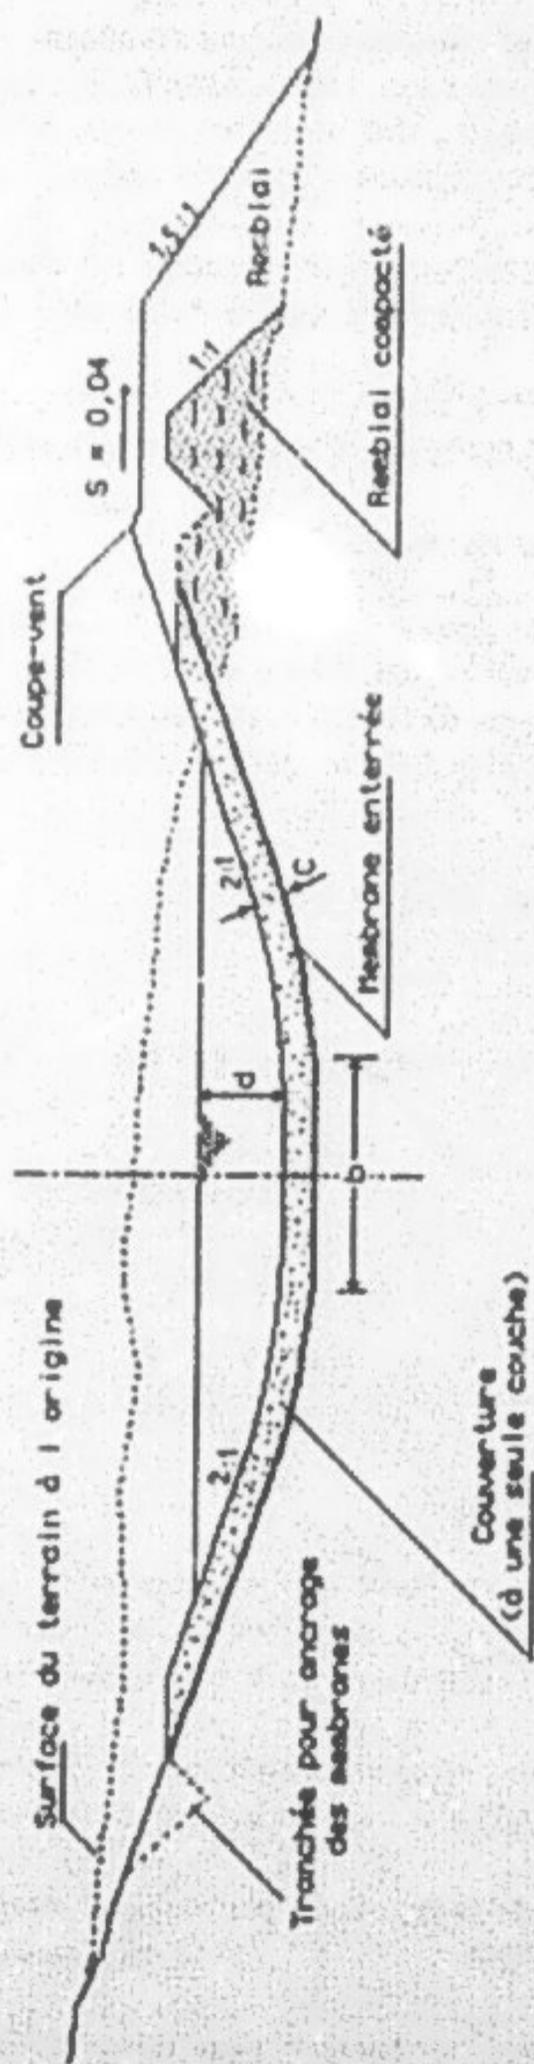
Section transversale type de l'installation d'un revêtement par membrane plastique enterrée
